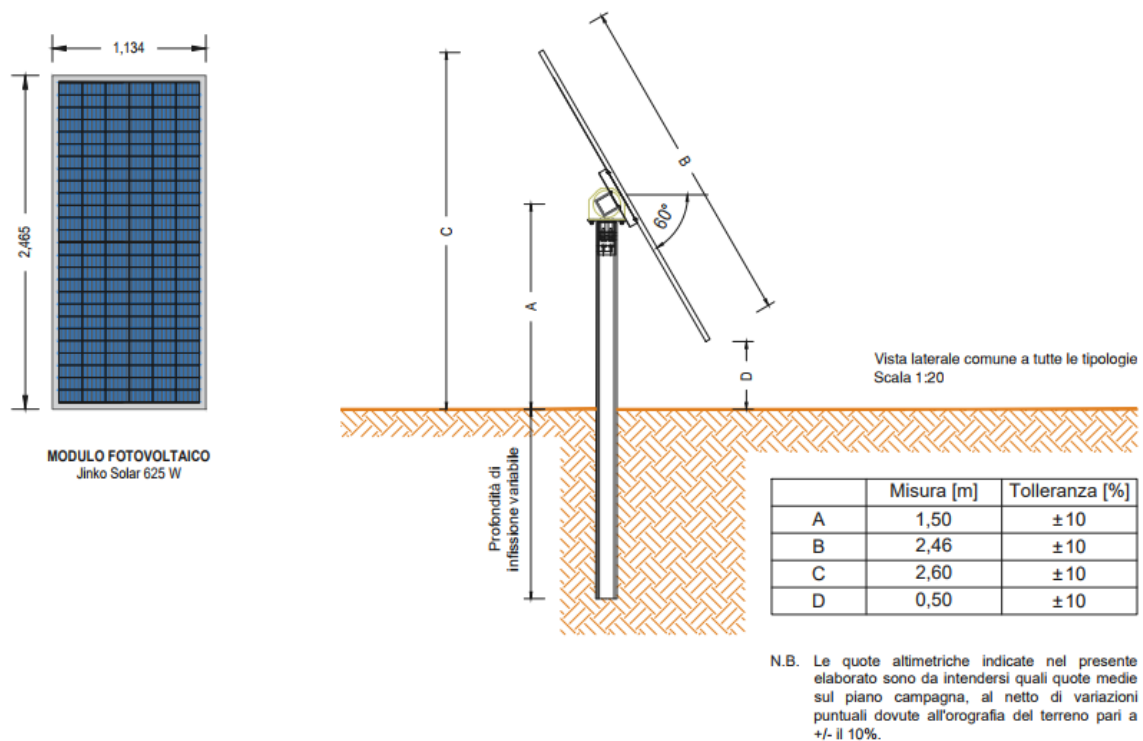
Dettaglio pannello Jinko N-type di progetto e sezione trasversale della struttura ad inseguimento monoassiale
